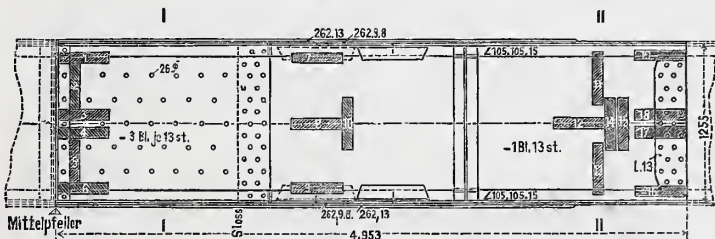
Seitenansicht mit Bezeichnung der Stegblechproben.
